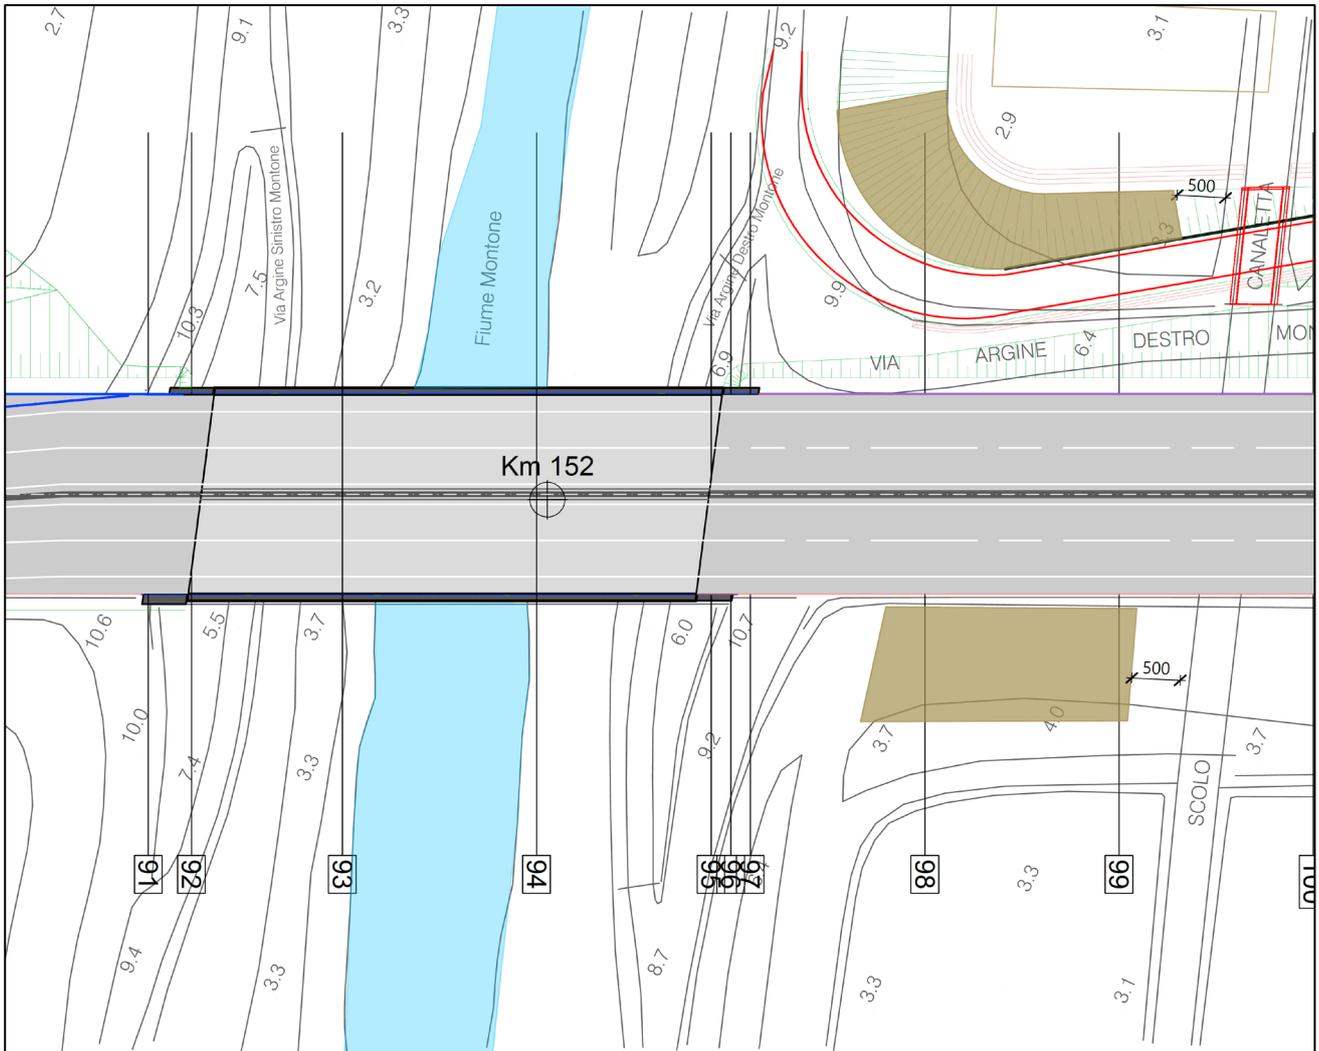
Planimetria Tratto A – 4 Aree di sistemazioni a verde
